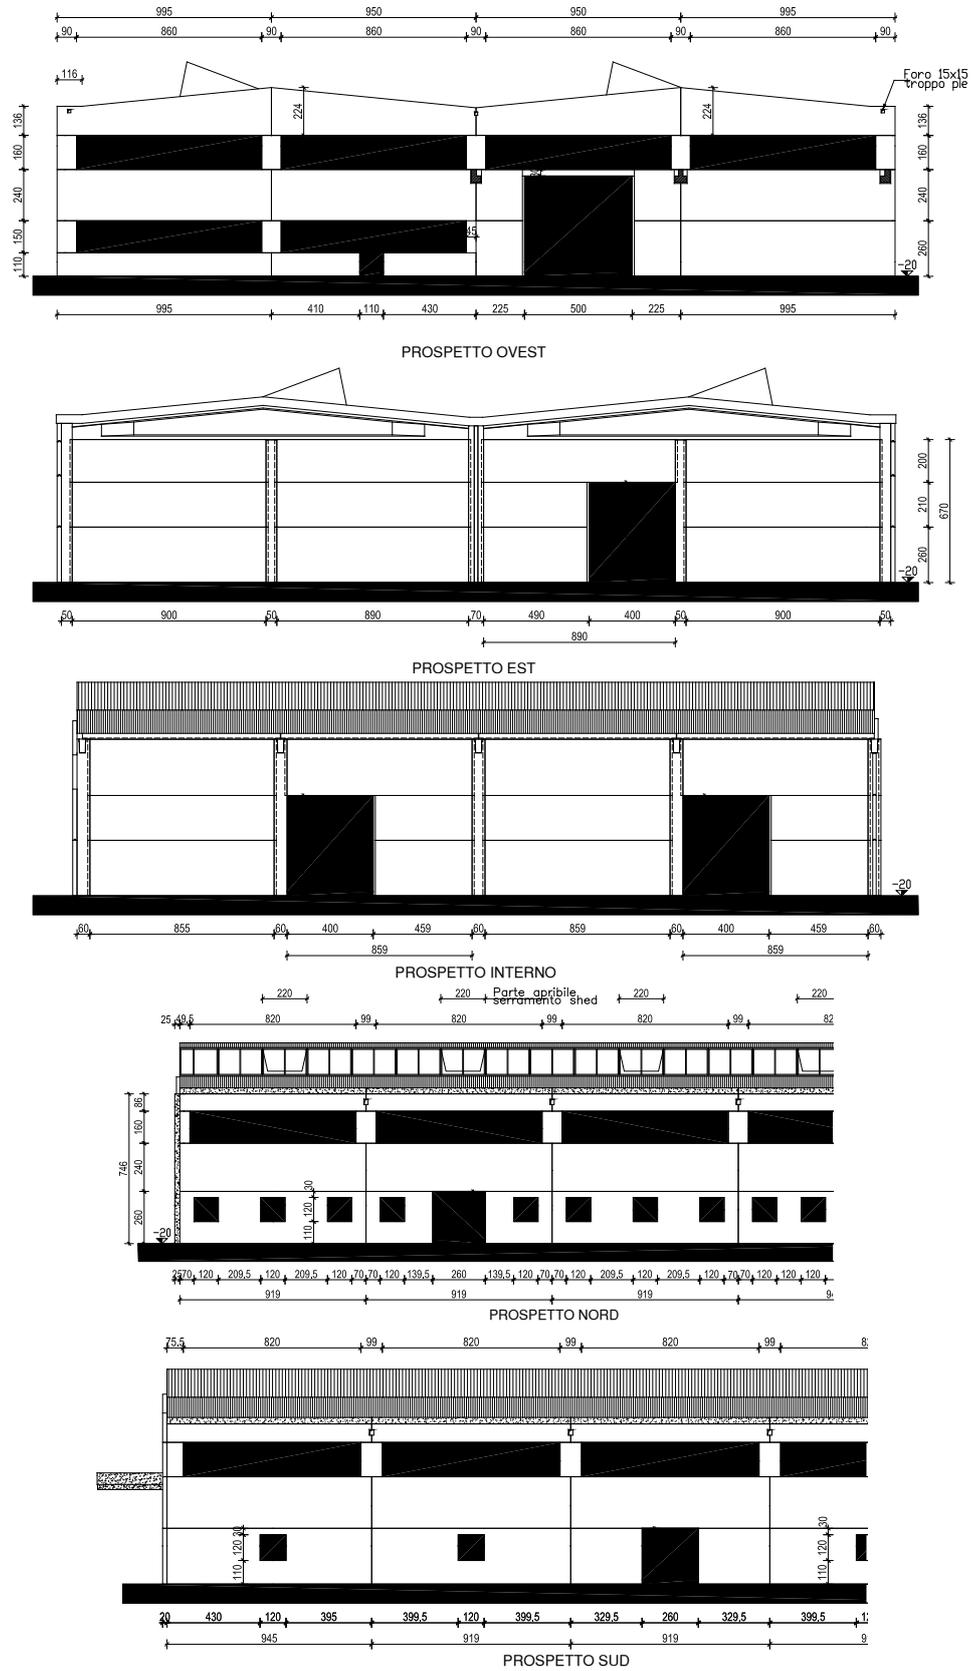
Prospetti edificio prefabbricato monopiano (anno 1996)
